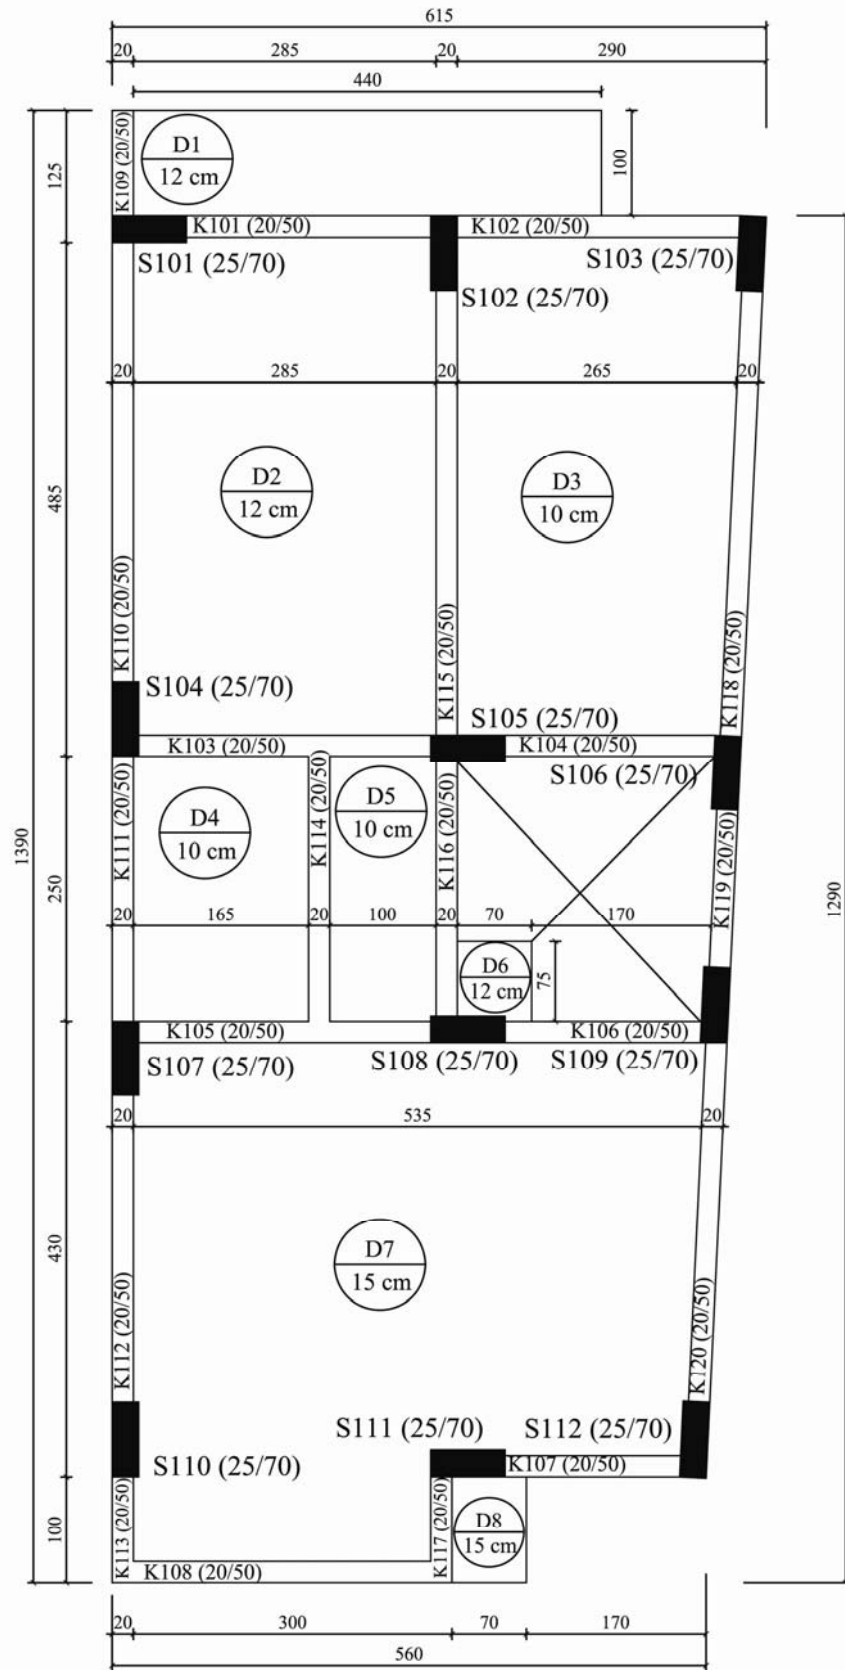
B5\_3'ün kat kalıp planı
